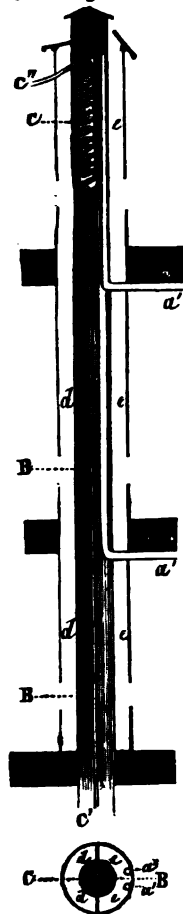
Coupe et plan (échelle double). B, B, b, cheminée d'évacuation et sa mitre. — a', a', conduits amenant dans cette cheminée l'air pris sous le plancher des loges. (C'est par erreur qu'on a, sur le plan, figuré dans la cheminée e, e la section de ces conduits; ils devraient occuper la même position dans la cheminée B.) — d, d, cheminée concentrique à la première fermée en haut pour chauffer. — e, e, autre cheminée, concentrique à la cheminée d'évacuation, ouverte en haut pour ventiler.
